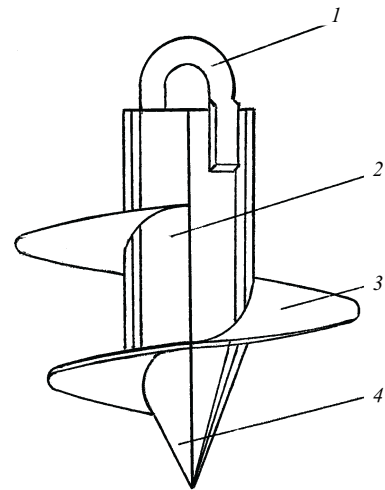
Винтовой анкер сварной – ВАС (широколопастный):
